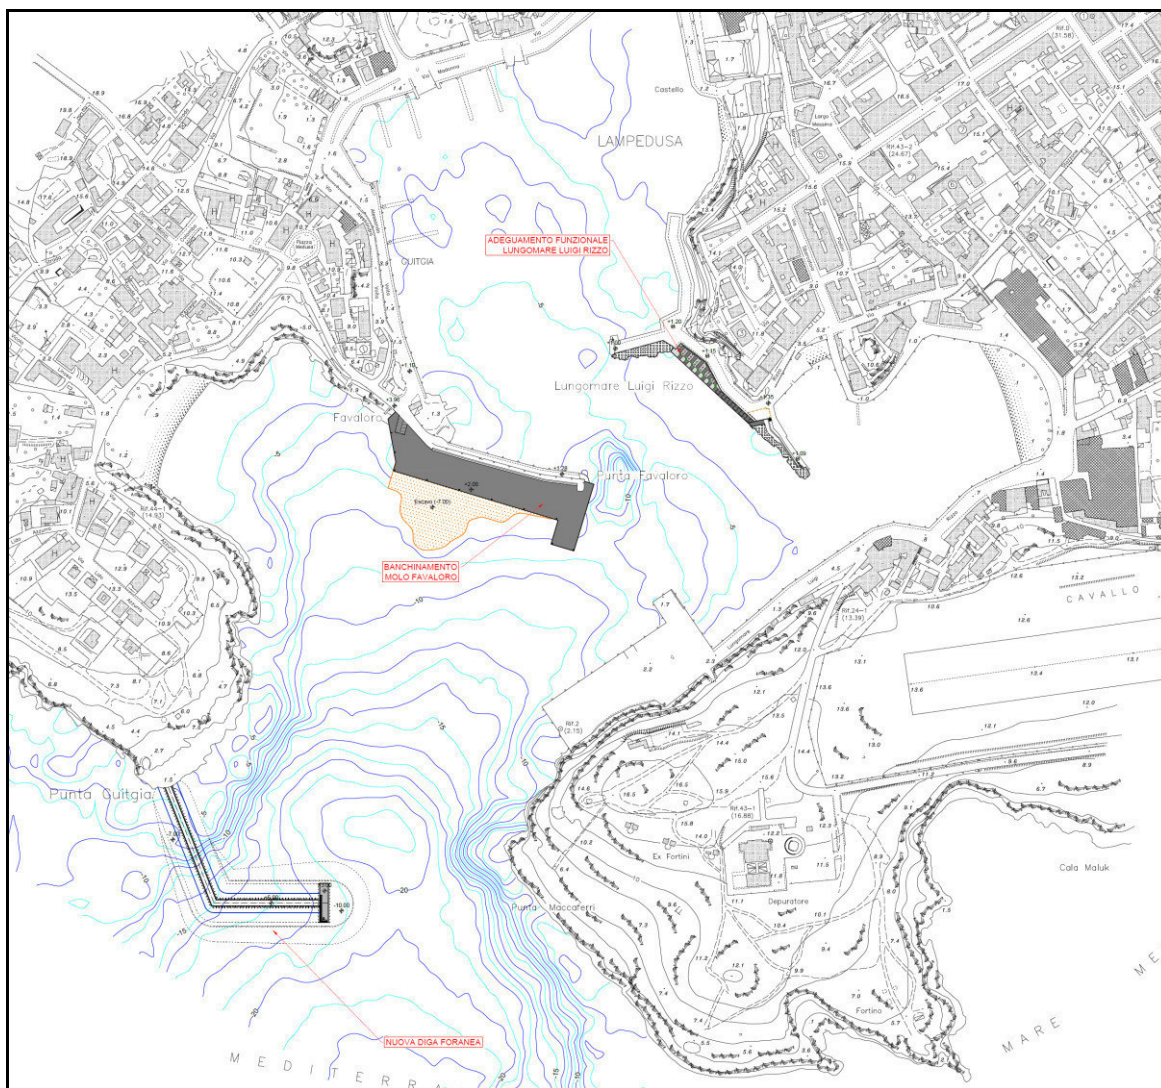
planimetria generale delle opere di progetto (fuori scala)
